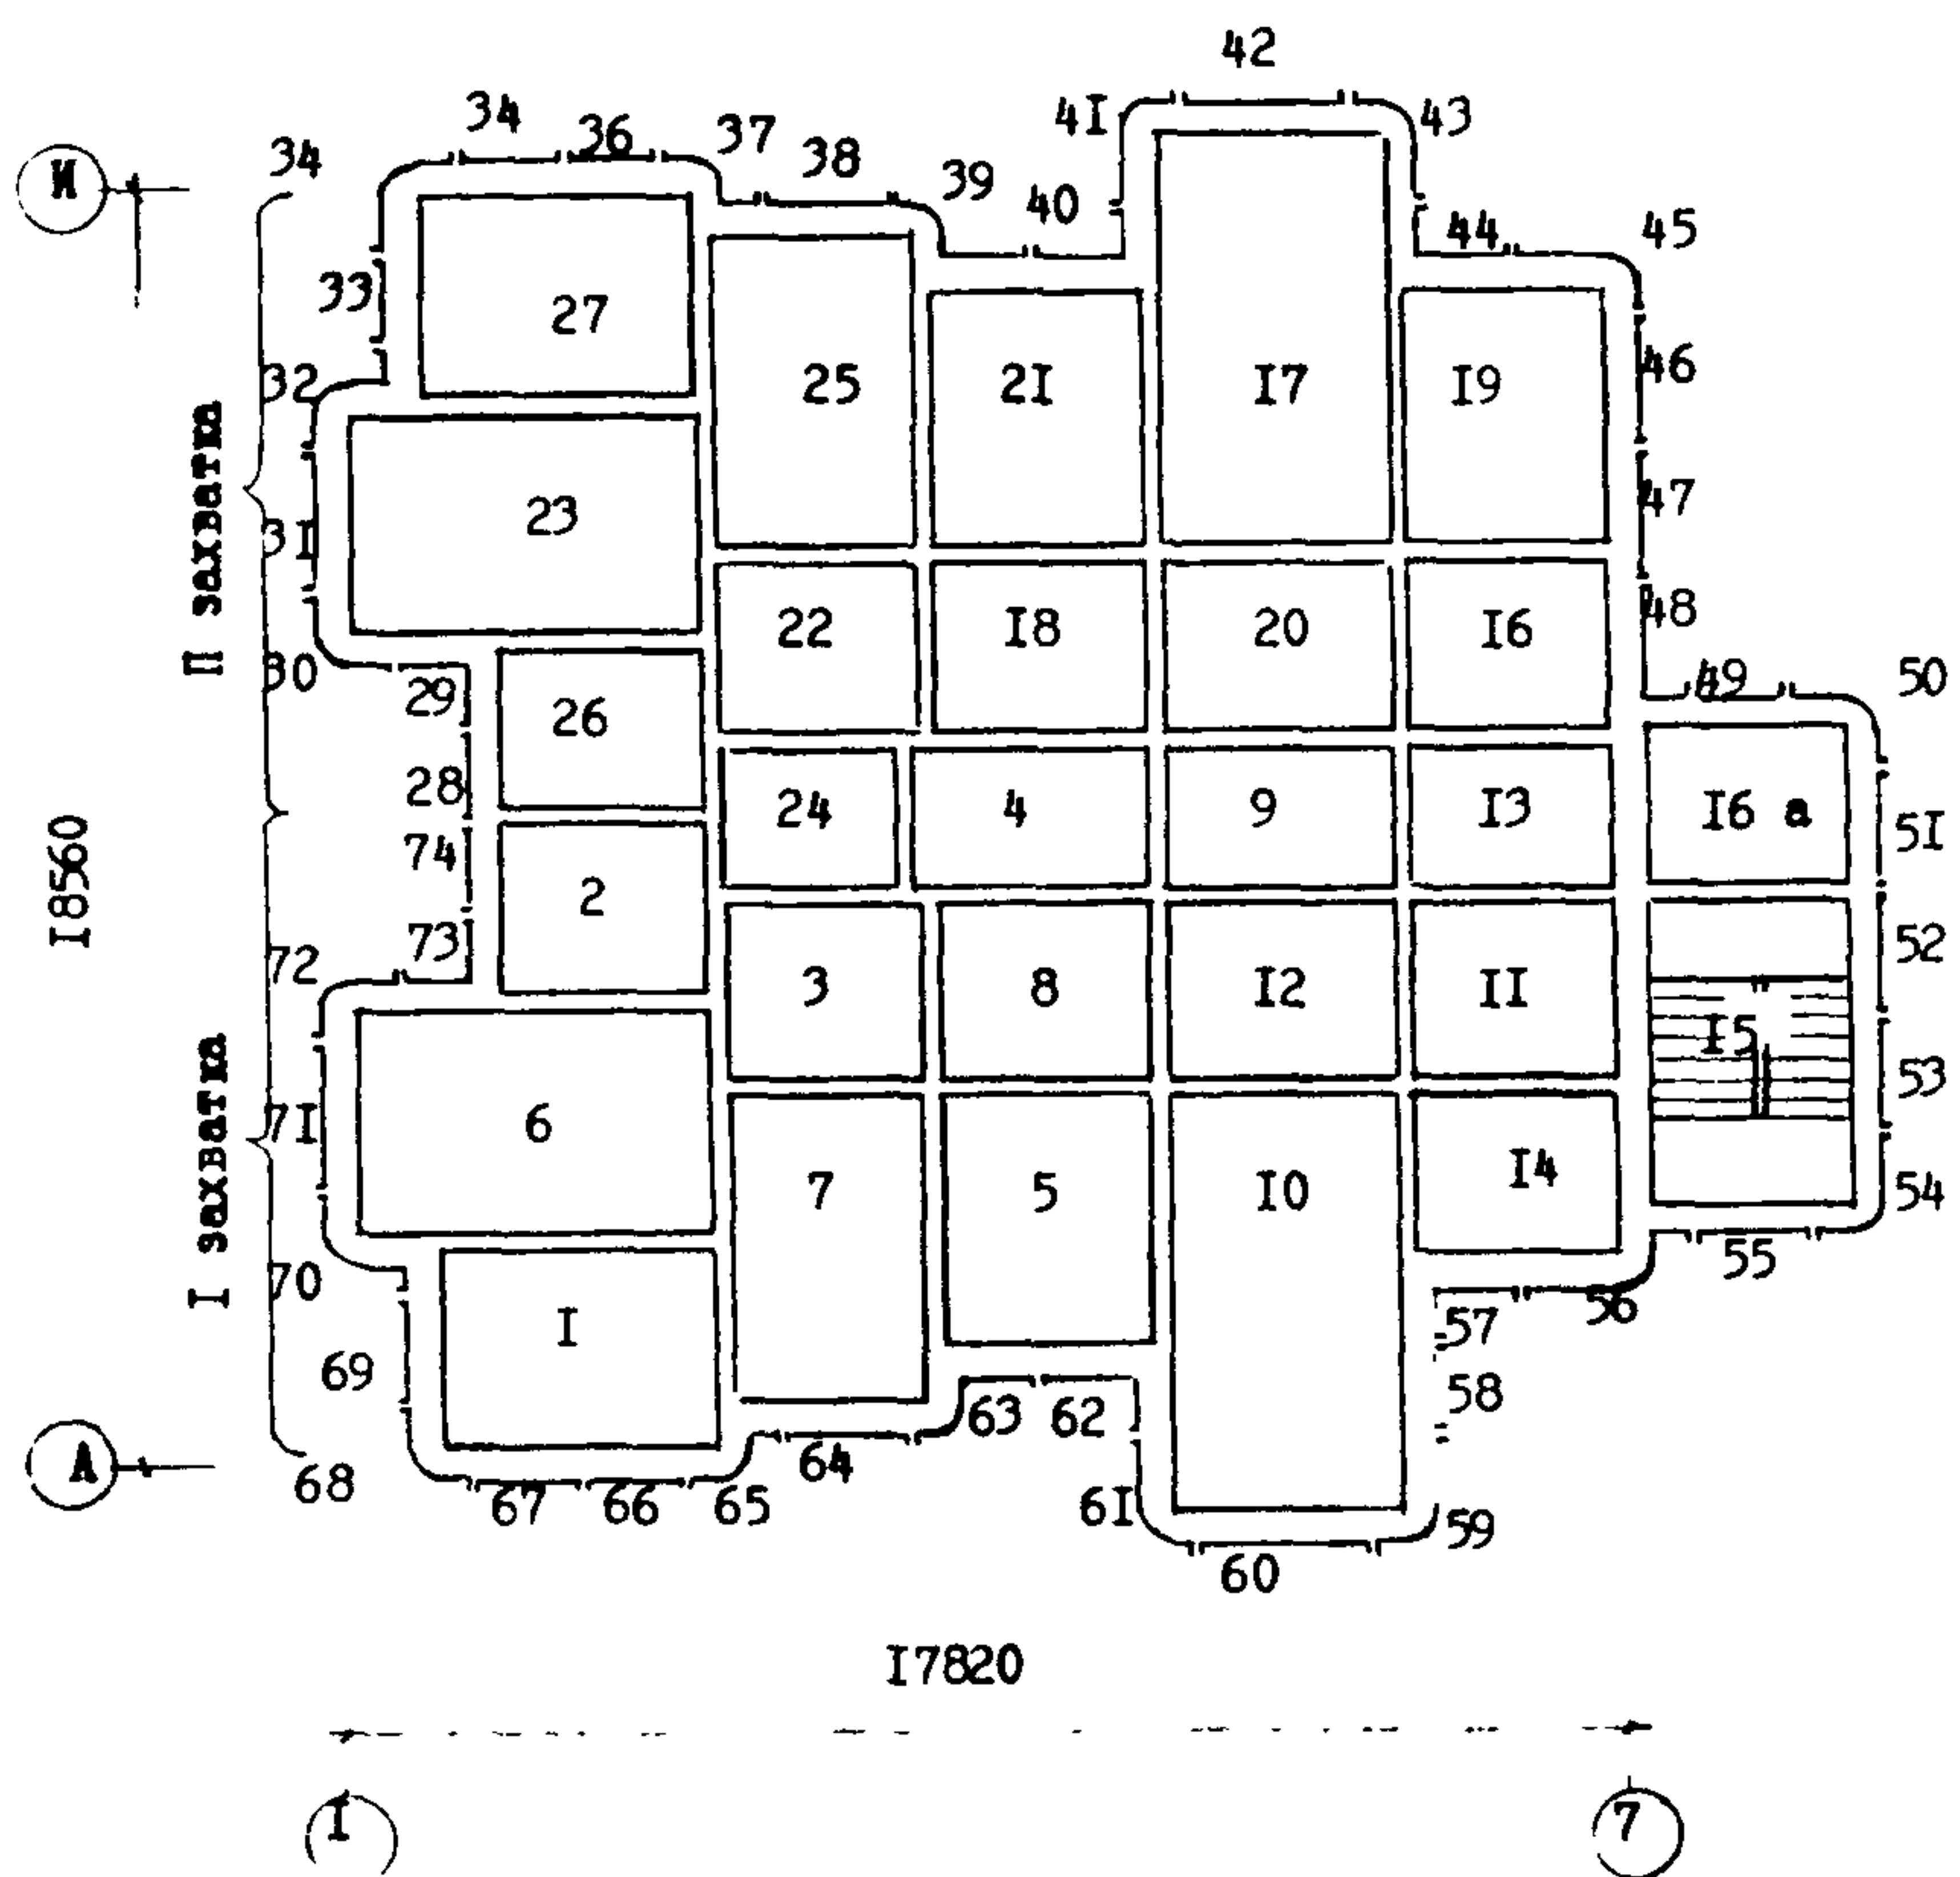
Схема монтажа внутренних коробов и наружных щитов опалубки:
